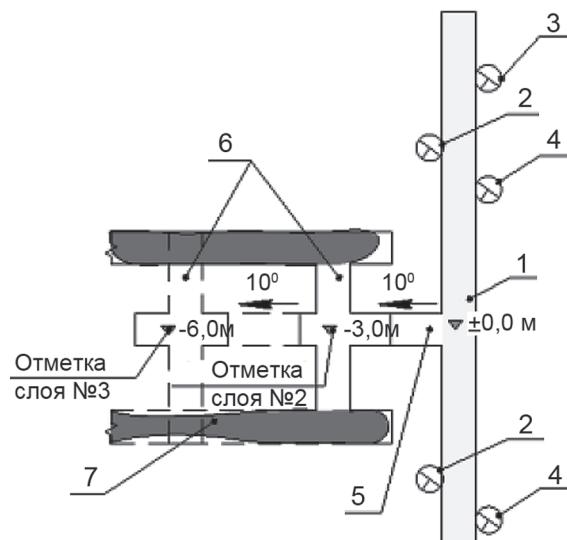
Отработка слоев № 2 и 3: 1 — слоевой орт № 1 на уровне верхнего горизонта — вентиляционный орт; 2 — рудоспуск; 3 — восстающий вент. ходовой; 4 — материальный восстающий; 5 — локальный съезд; 6 — разрезной орт; 7 — очистная заходка
